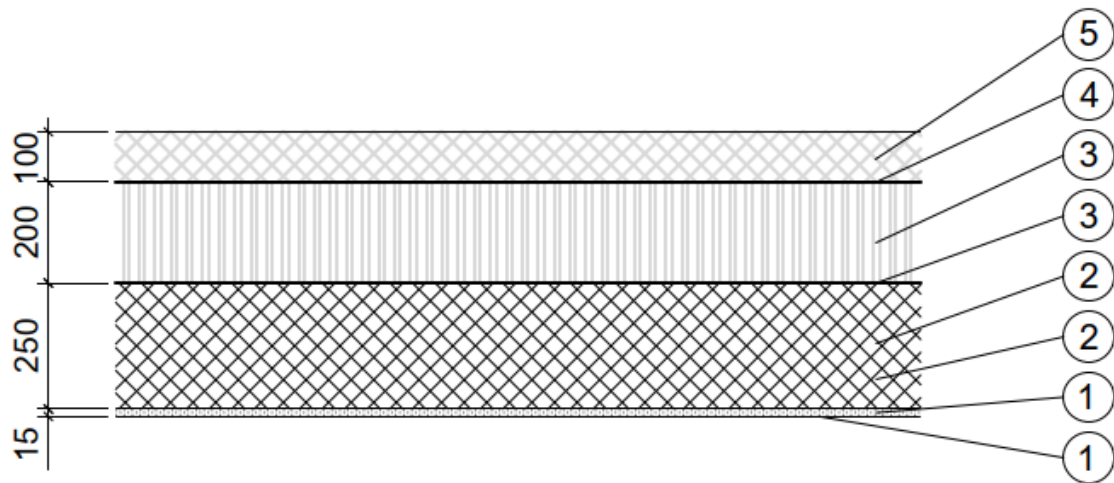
Aufbau Stahlbetonfassade mit Aussendämmung und vorgehängten Stahlbetonelementen
